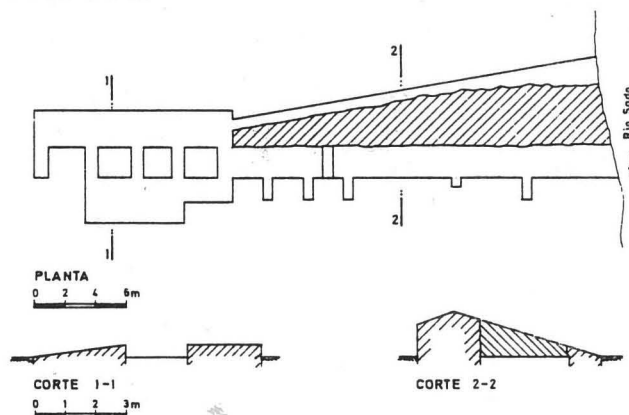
Açude da Torre Vã. Esboço da planta e perfis. Na zona da planta a tracejado inclinado para a direita não se observam vestígios de construção.
